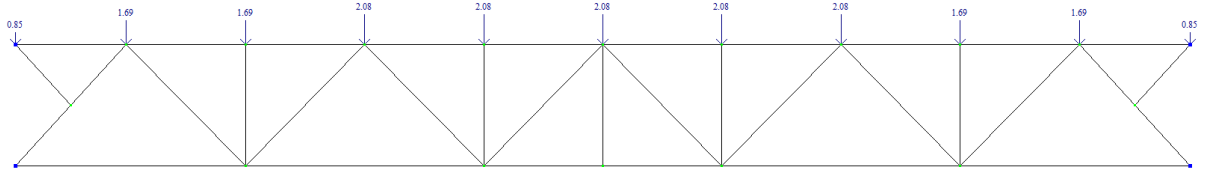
Загрузка 2 (пирог кровли)
